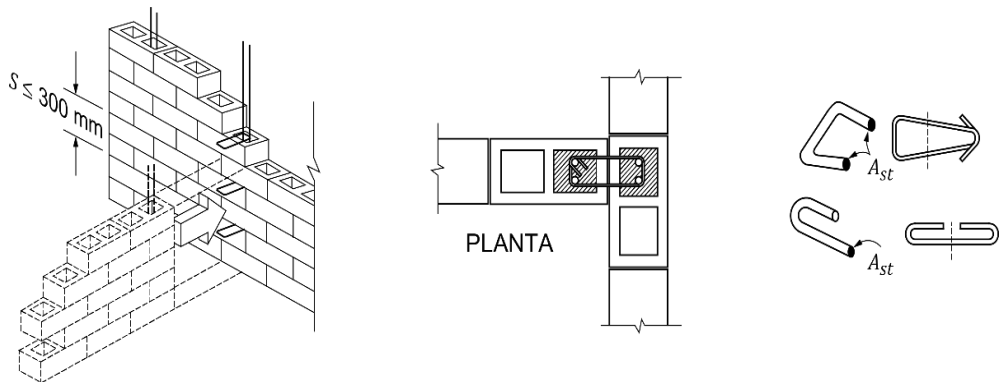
Conectores entre muros sin traslape de piezas
